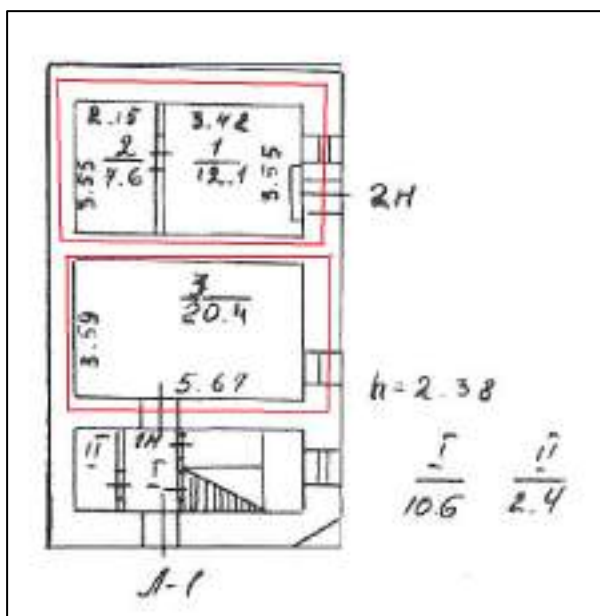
План оцениваемых помещений 1- Н - 2-Н Синопская набережная, 24 В
